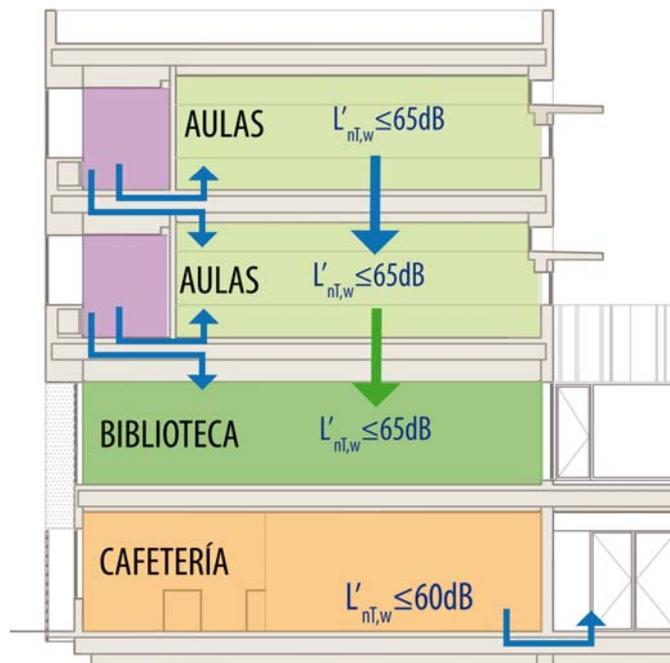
Detalle sección por la cafetería con indicación de exigencias aplicables a ruido de impactos.
